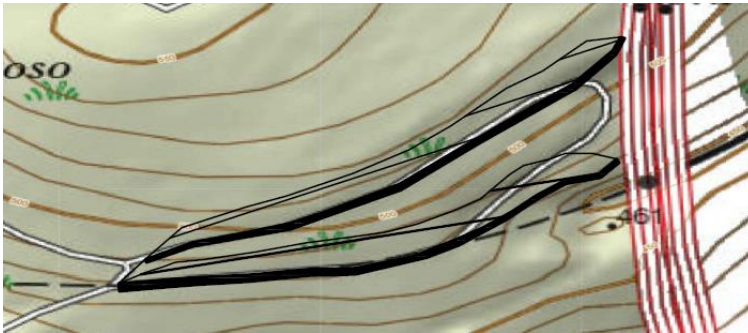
Terraplén de camino a Pila 1 y Estribo 1
